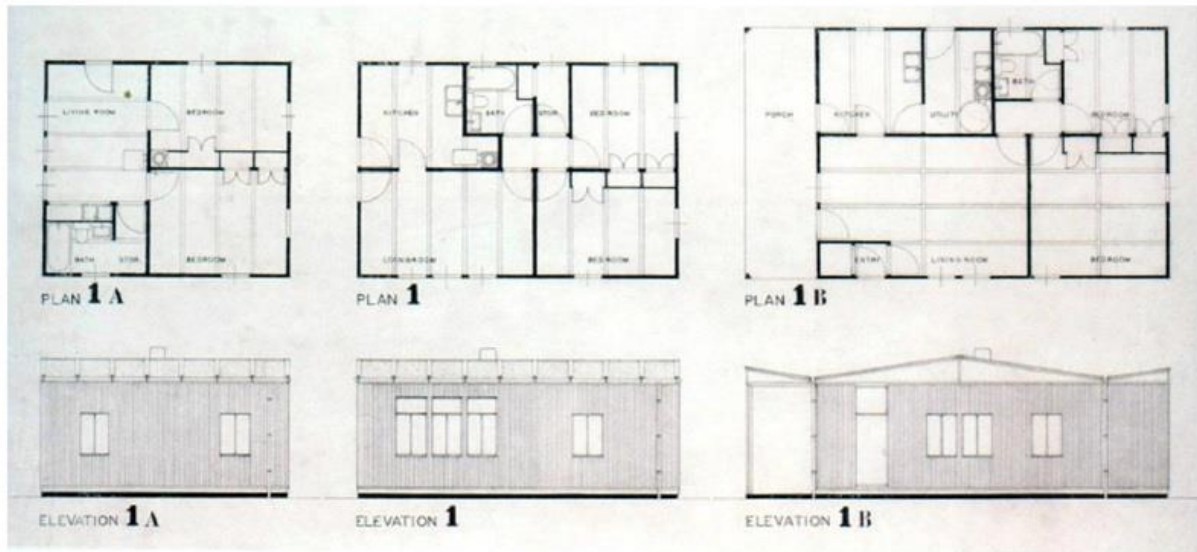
Plans et élévations pour trois propositions de maisons individuelles à partir d'un module standardisé.
